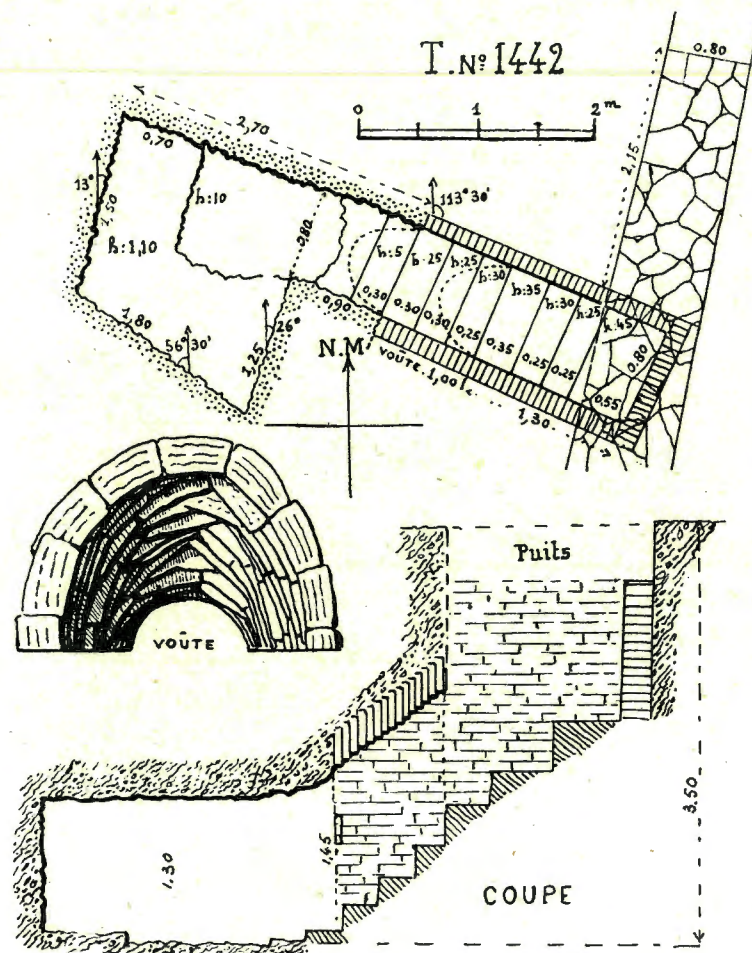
Plan et coupe de la tombe n° 1442. Appareil de la voûte.
